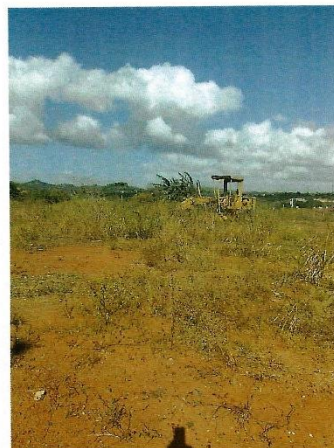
Vista general. Tramo prospectado. Alterado por maquinaria de proyectos previos este.
